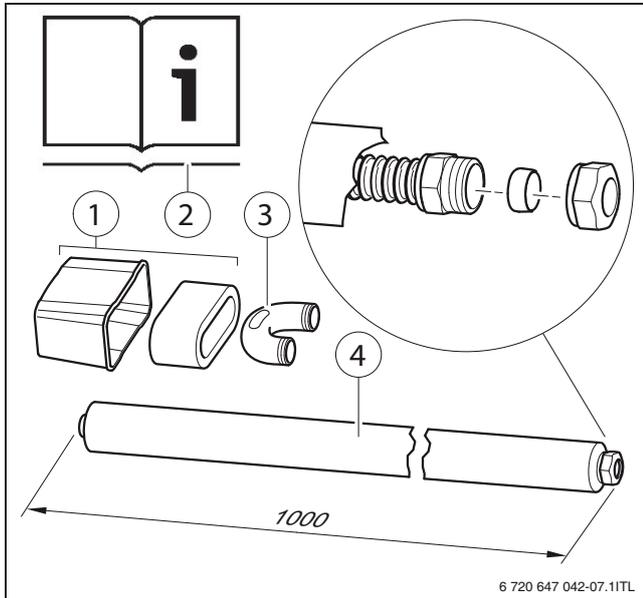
Volume di fornitura kit di raccordo SKR per installazione sul tetto
